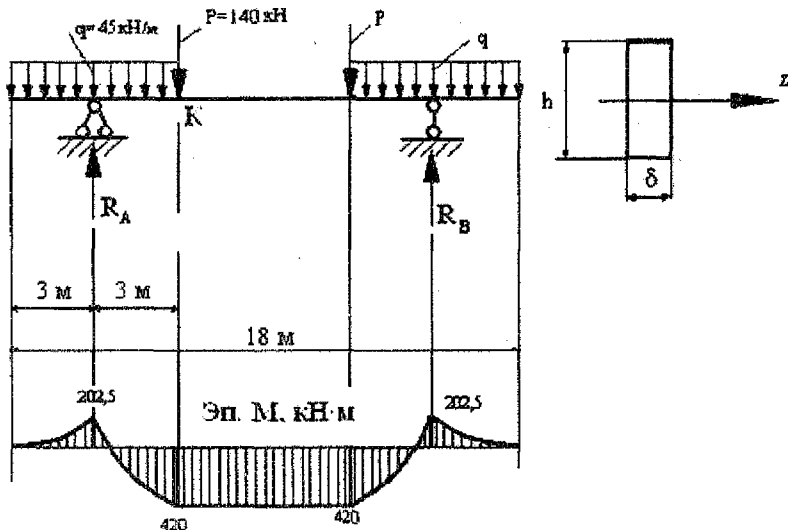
К расчету балки-стенки по балочной схеме (метод сопротивления материалов)
